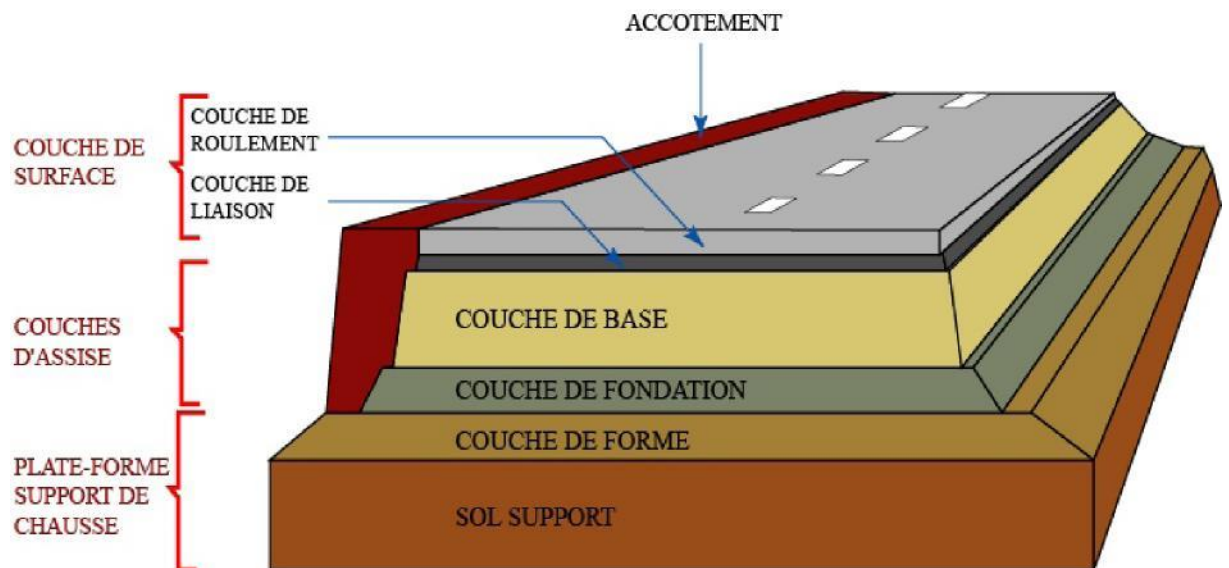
Coupe type d'une structure de chaussée souple.
